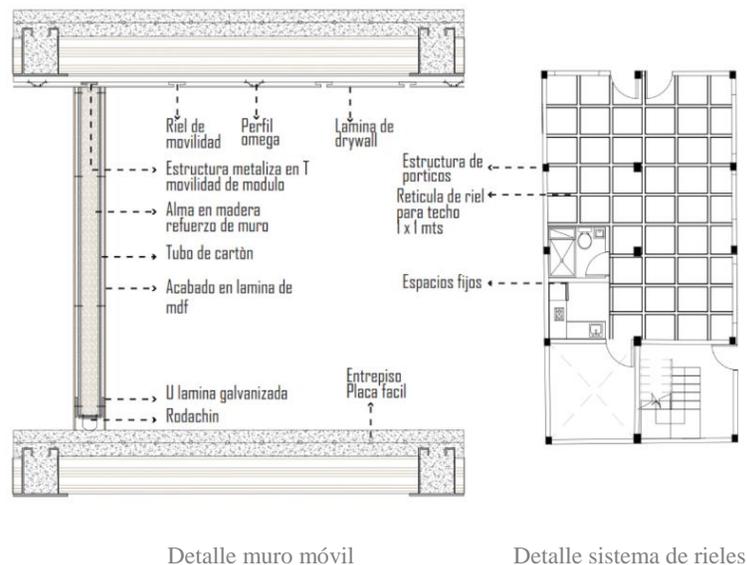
Detalle módulo de muro móvil y sistema de rieles.
